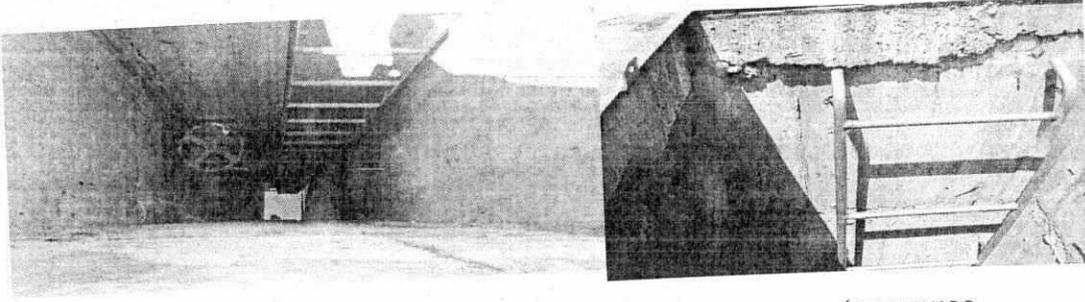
ALTURA DE LA TUBERÍA DE INGRESO Y LA TUBERÍA DE LAVADO
